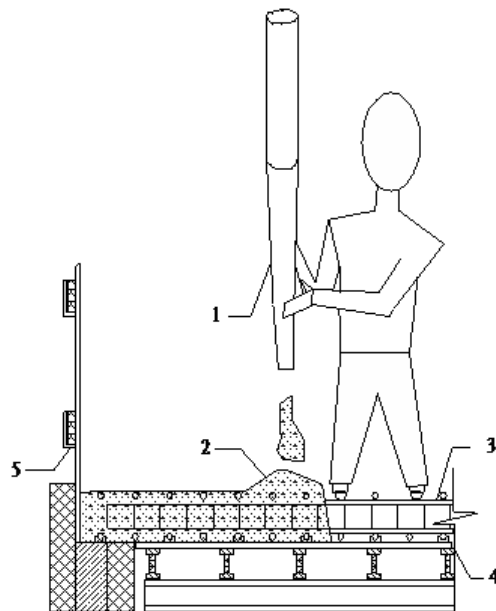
Укладка бетона с применением бетононасоса
